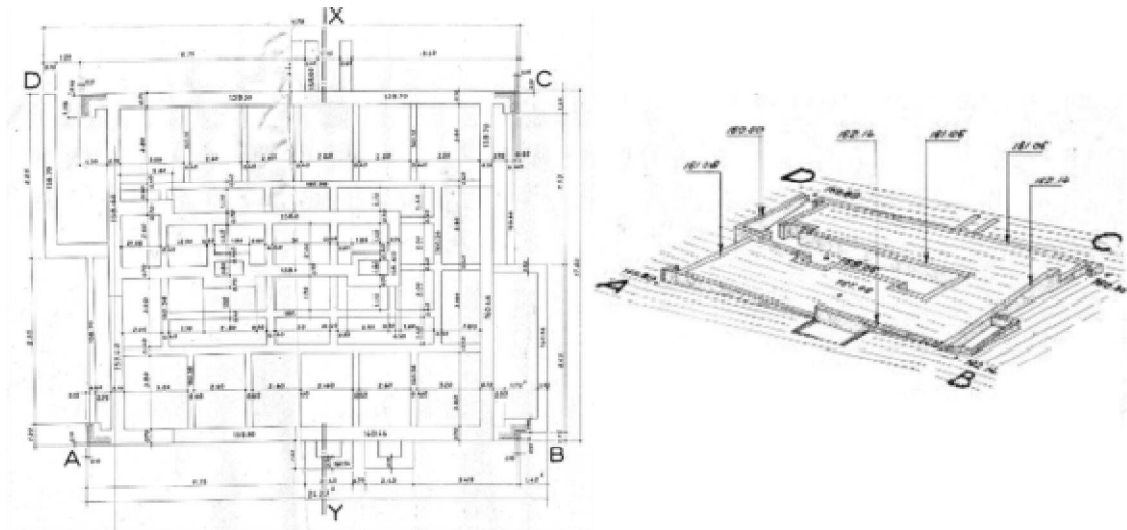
21: Vue en plan et la 3D des fondations bâtiment L [19].
